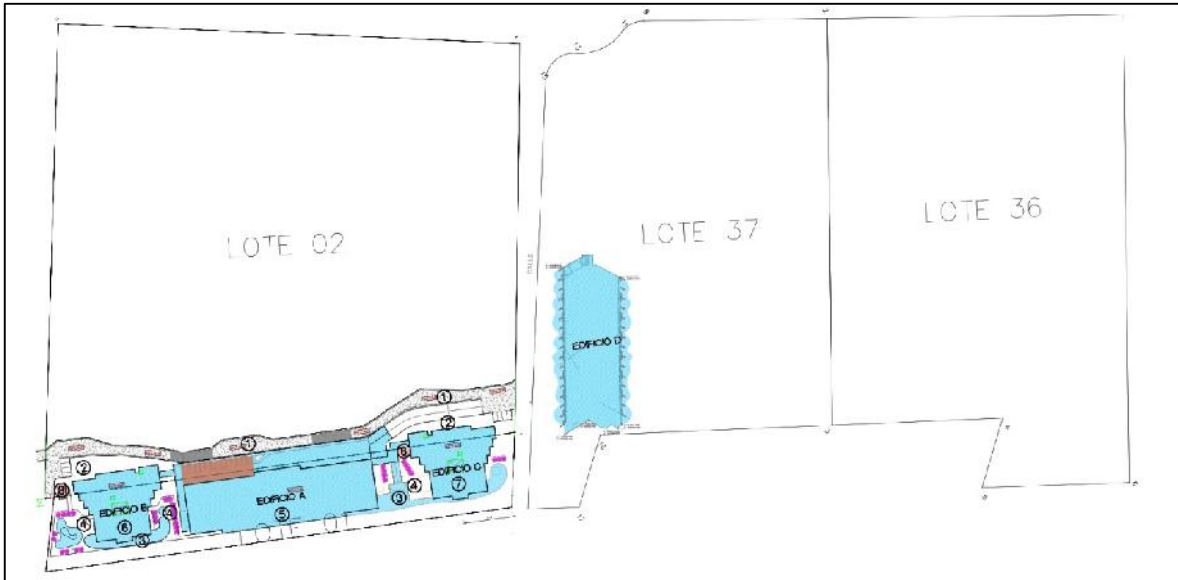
Planta de conjunto del PROYECTO. Se anexa plano señalando con leyenda las obras que conforma el PROYECTO.
